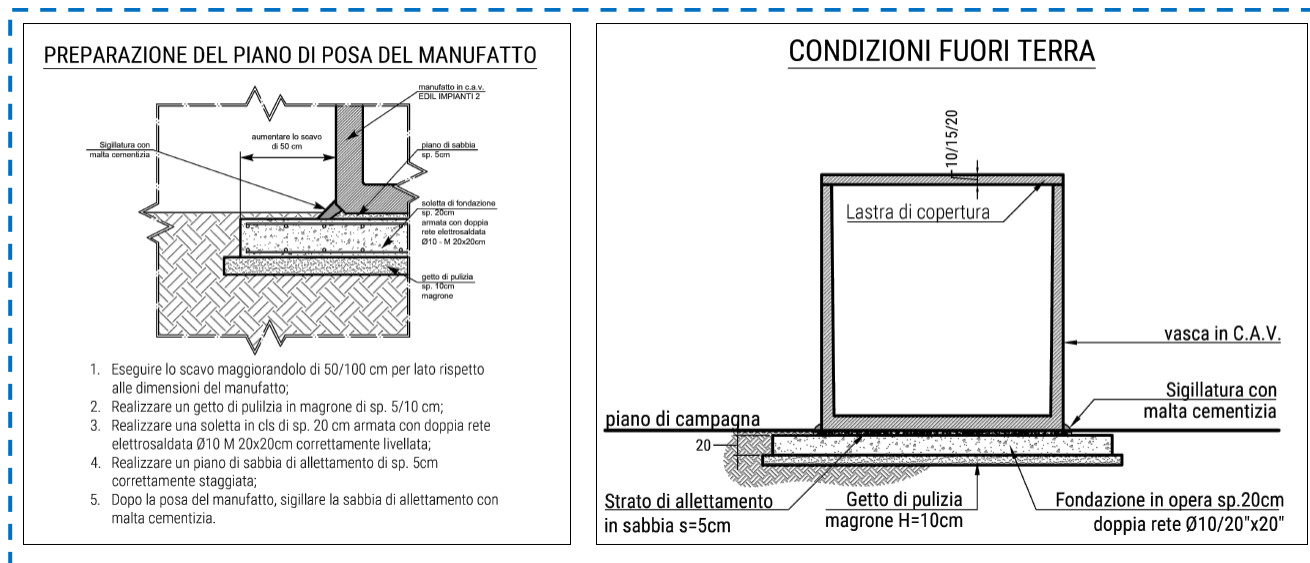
Estratto Tav.06 - Reti tecnologiche: dettagli vasche di accumulo
